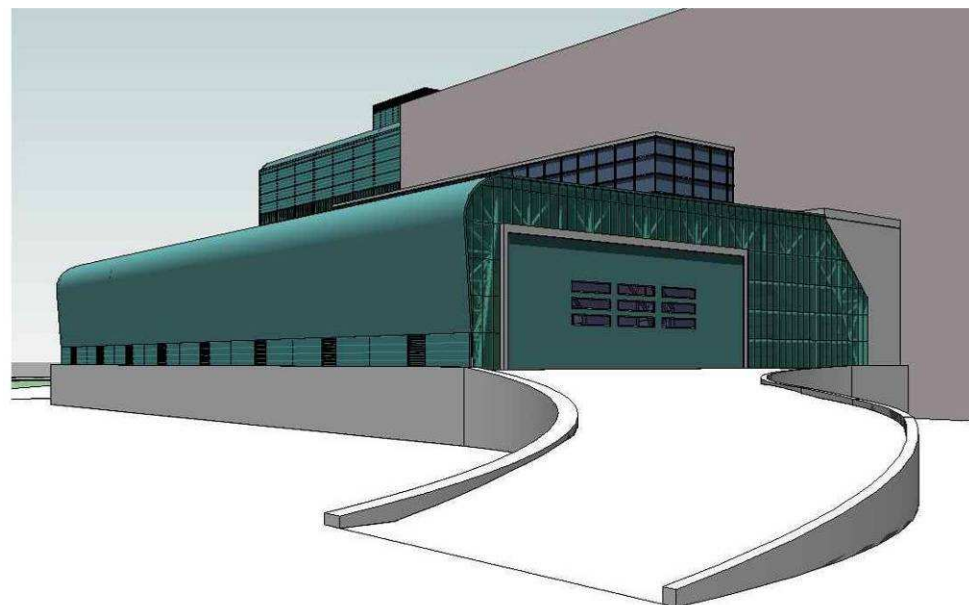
Vista assometrica esterna dell'avanfossa e del relativo accesso.
